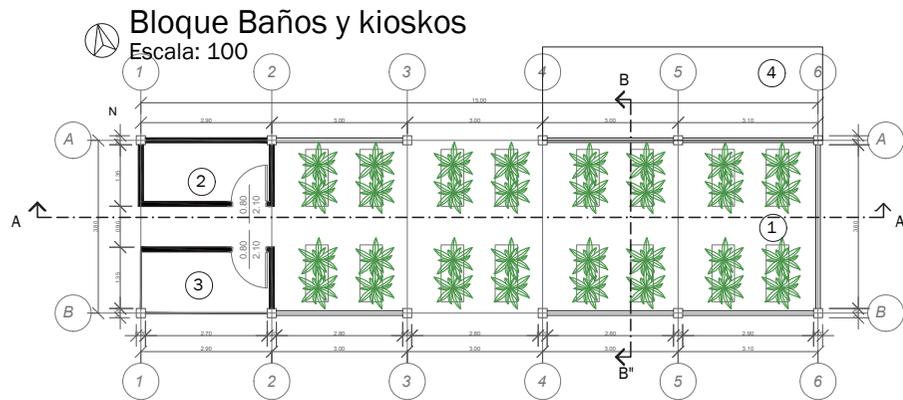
Detalles arquitectónicos bloques de baños y kioskos
